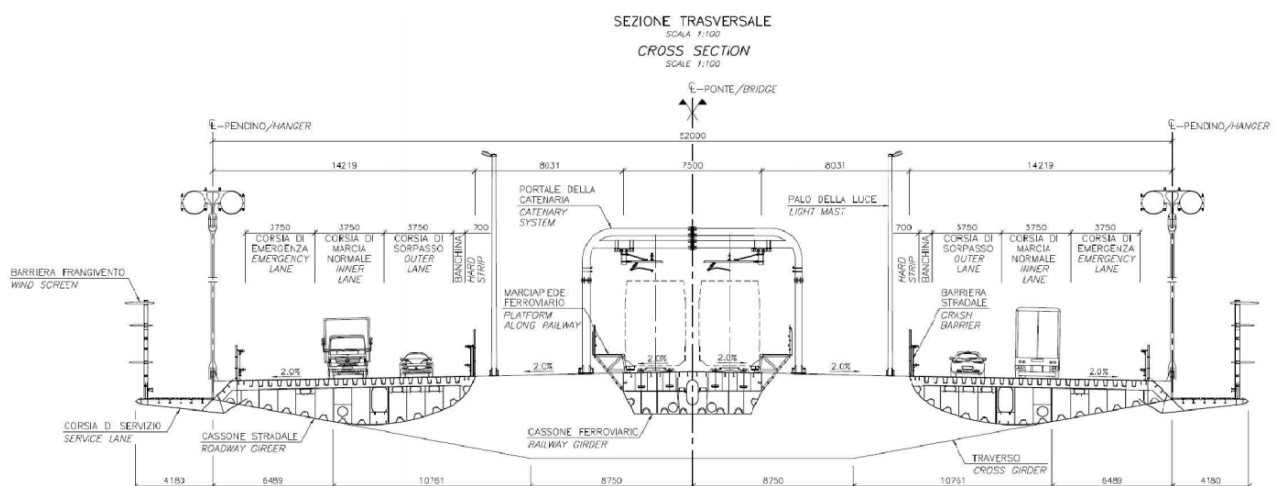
Sezione di impalcato del ponte – Progetto Preliminare 2002
